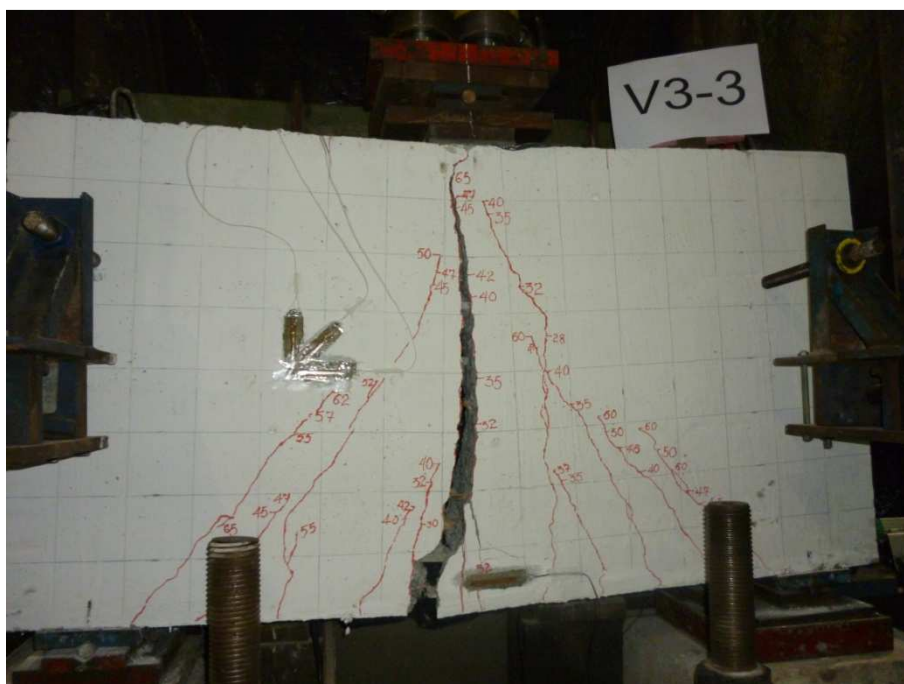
Configuração de fissuras - Viga V3-3.
